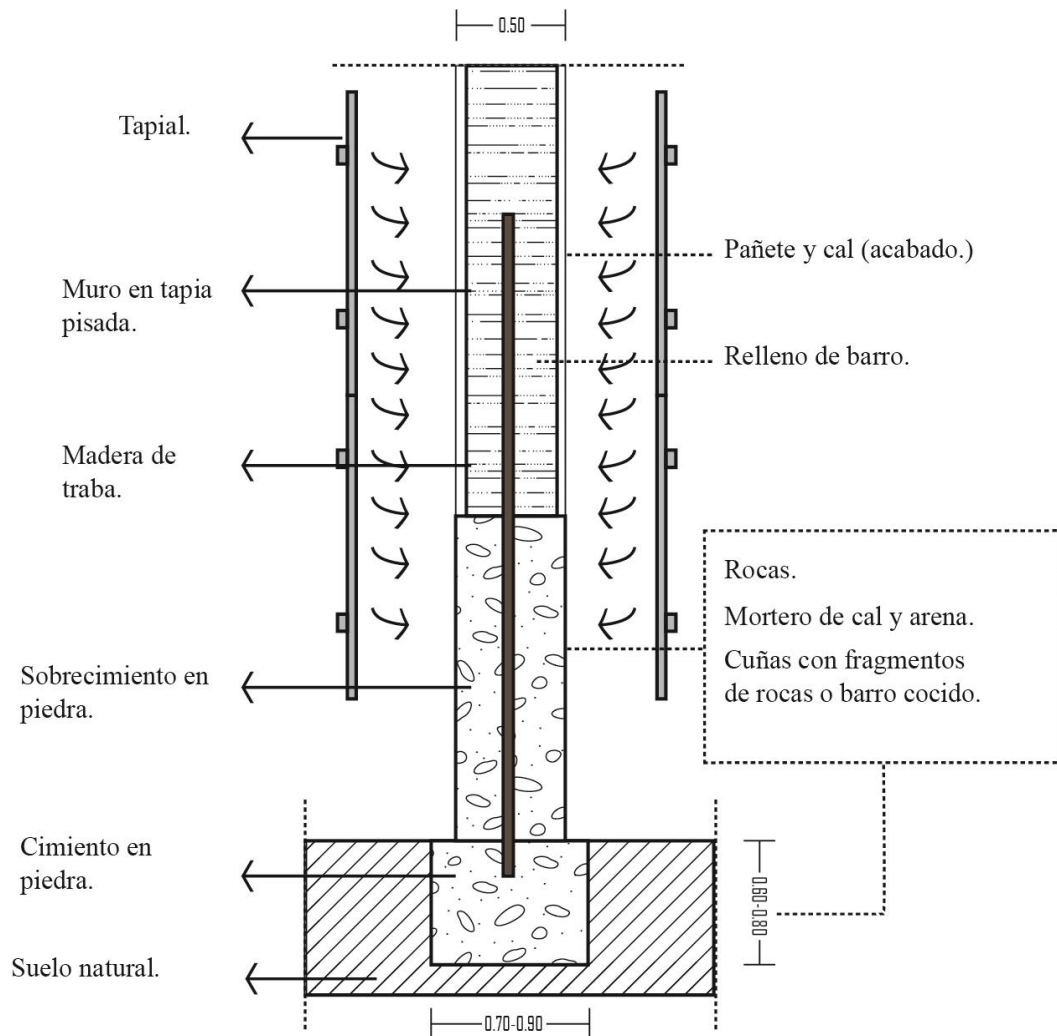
Detalle constructivo de muro en Tapia pisada y cimentación con piedra. Fuente: Autoría propia según fuentes bibliográficas: Minke G. (2005). Manual de construcción para viviendas antisísmicas de tierra..
